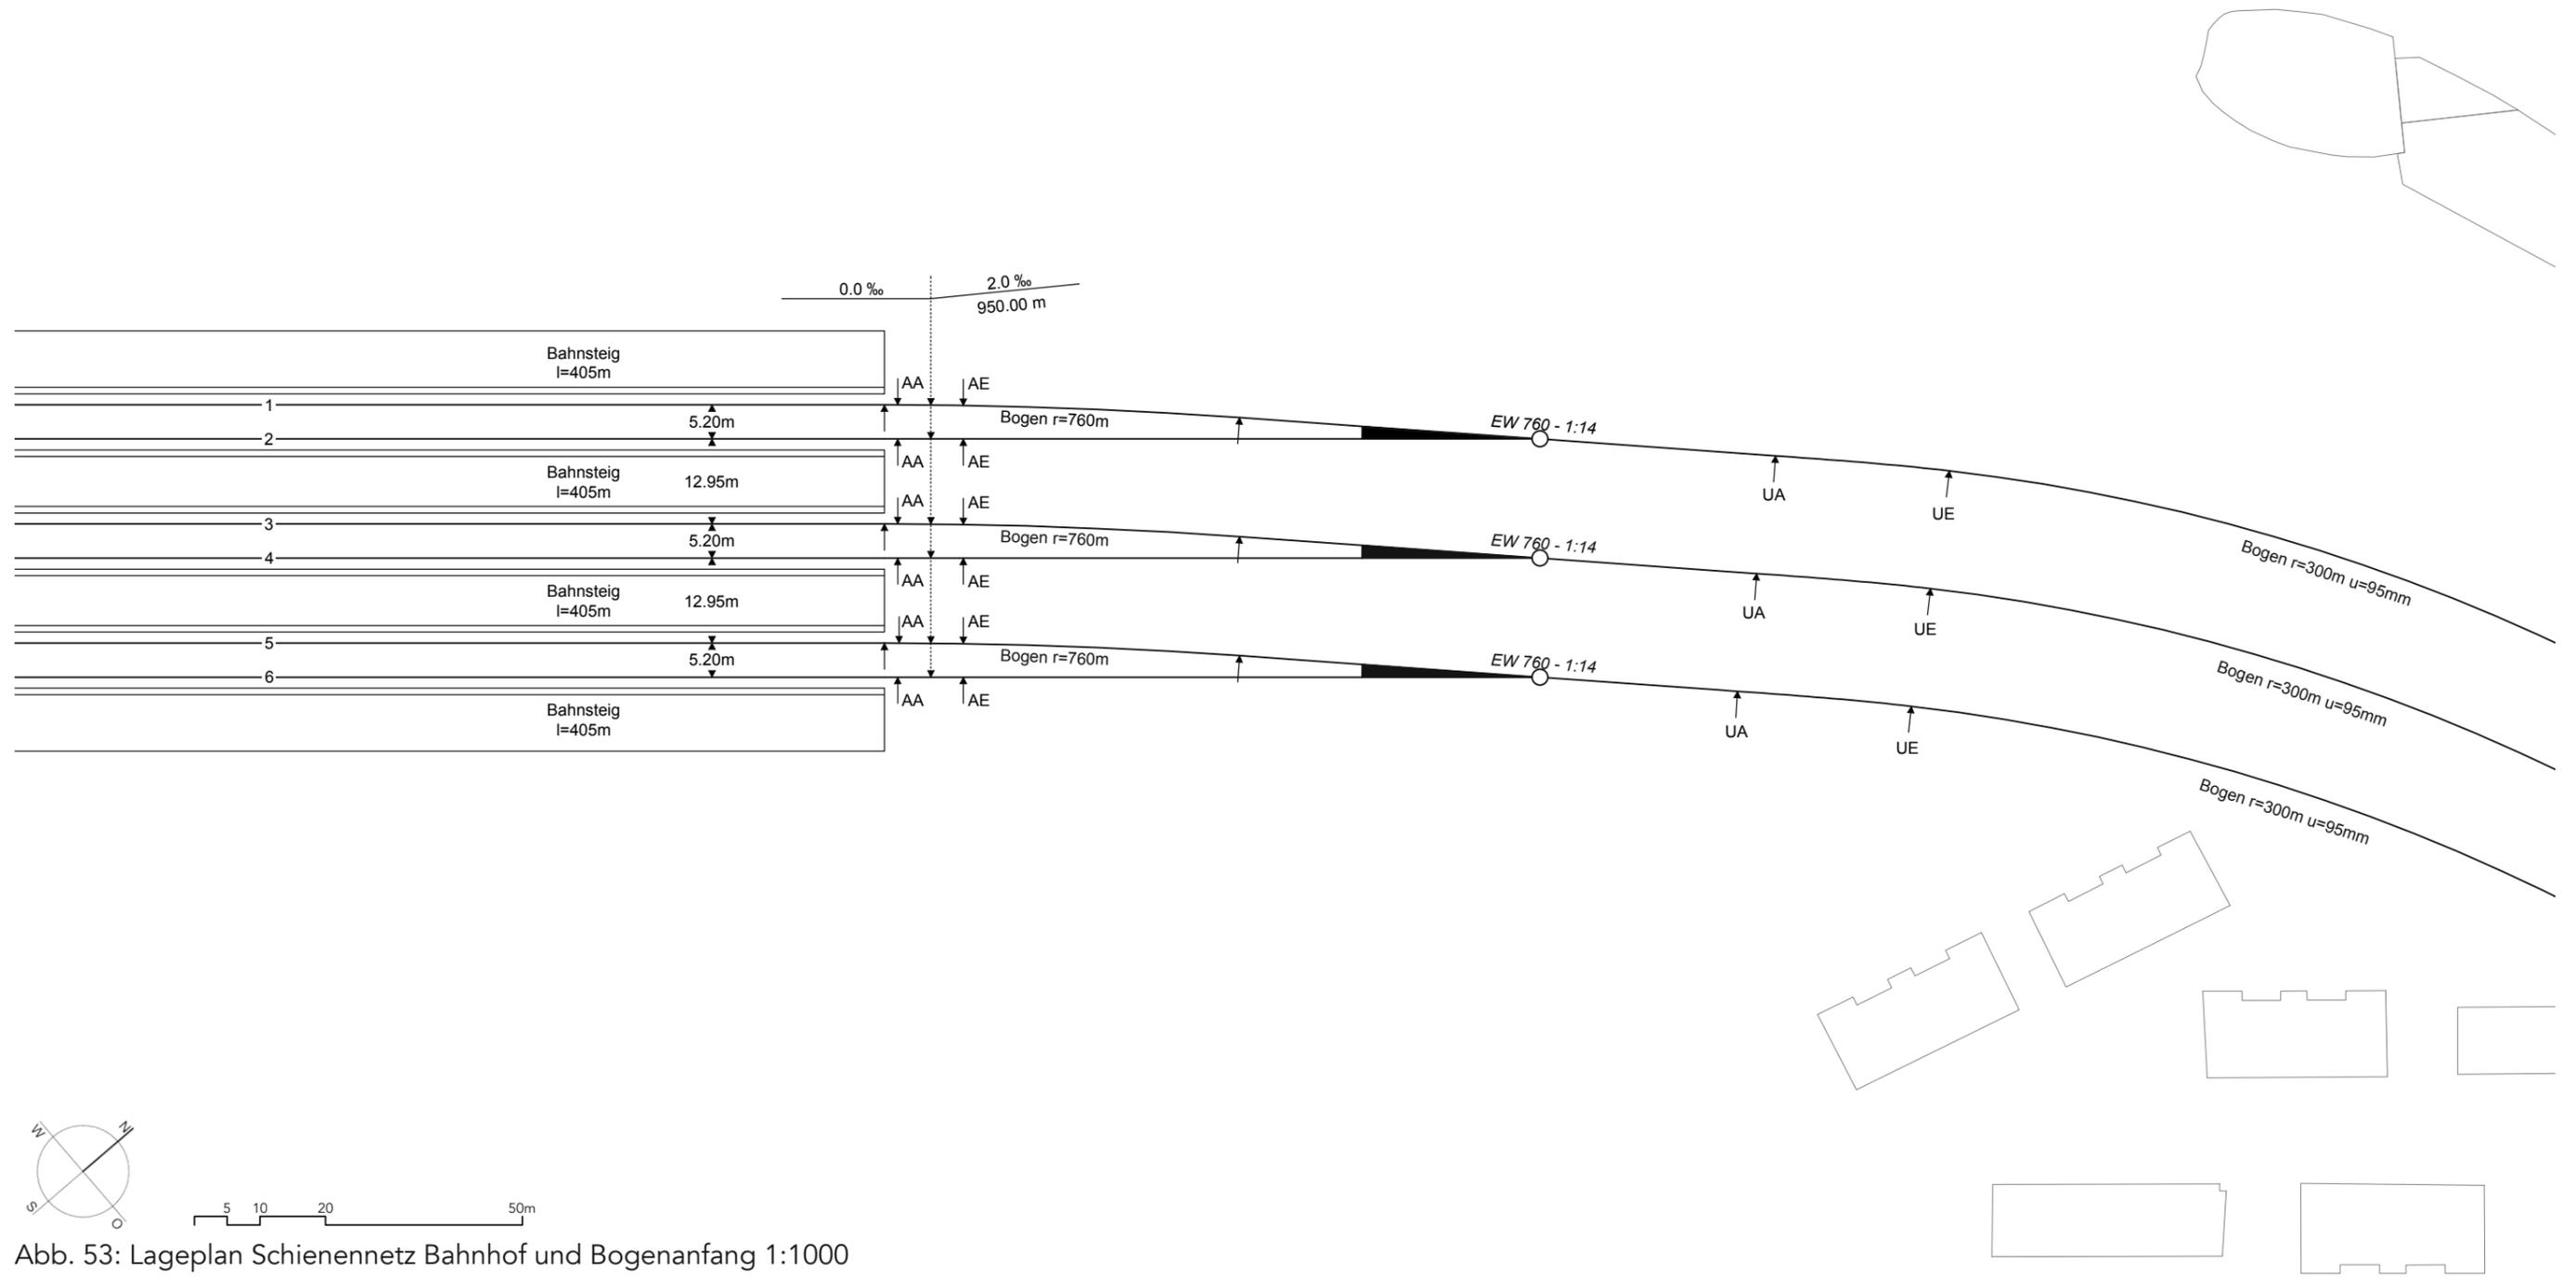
Lageplan Schienennetz Bahnhof und Bogenanfang 1:1000
